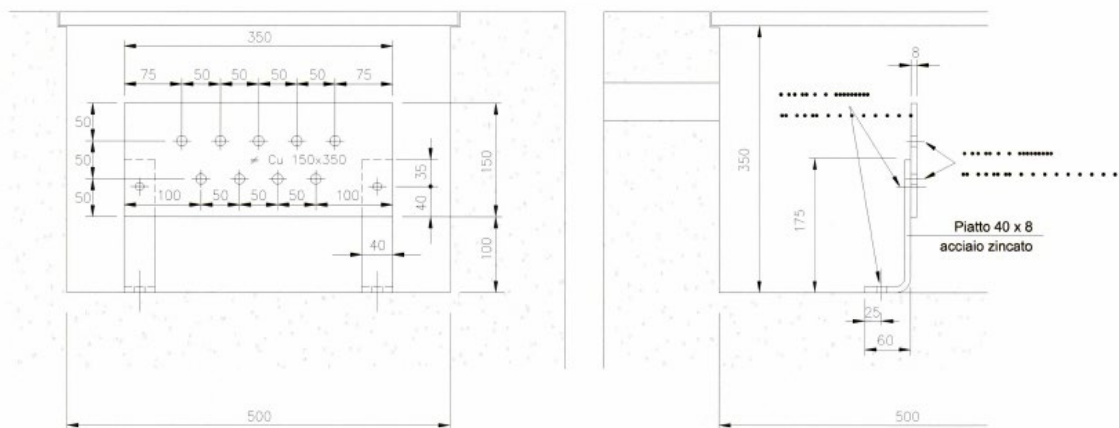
Piazzole BTS: geometria connessione a terra shelter
